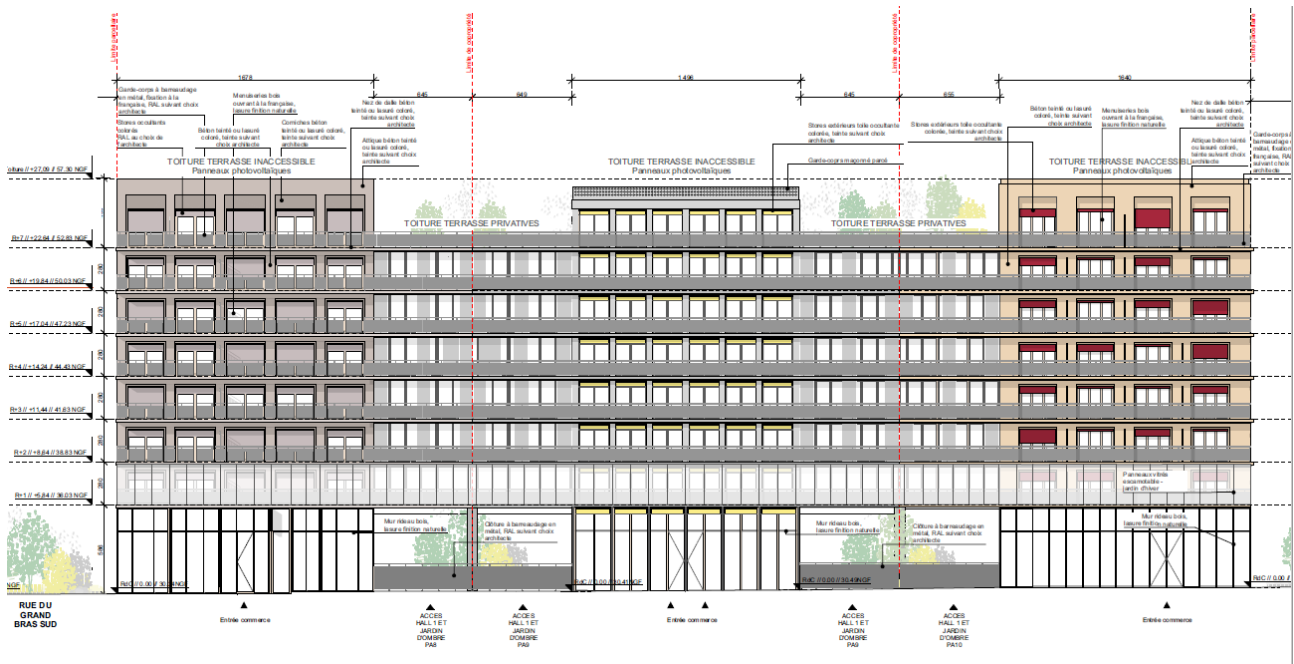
Plan des façades Est (source : PC 05.01, 29/06/2020)
